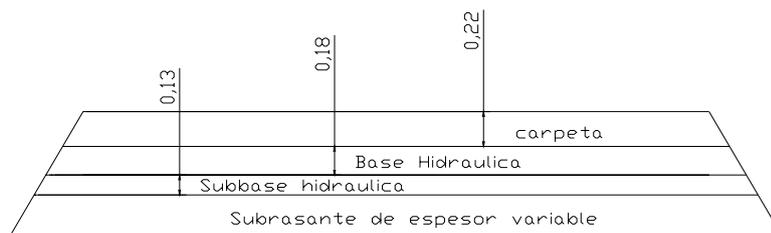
Estructura del pavimento detectada en su evaluación. (Acot. En metros)
